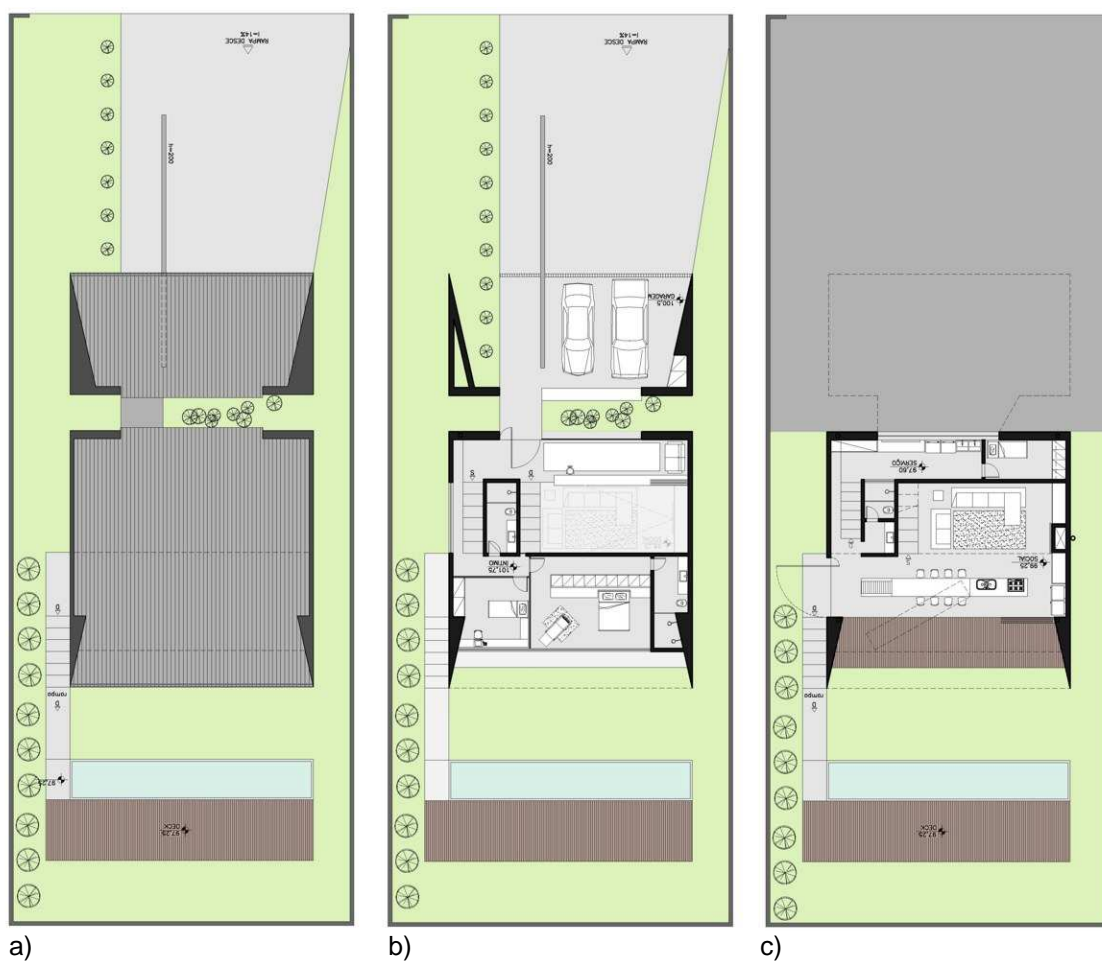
Primeira apresentação do anteprojeto – plantas
